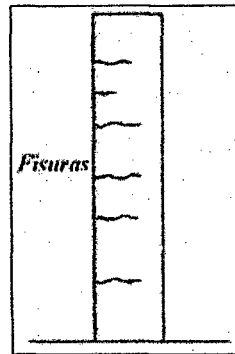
12. Fisuración transversal en pilares debida al pandeo. Fuente: (Stuardo P., 2008)
